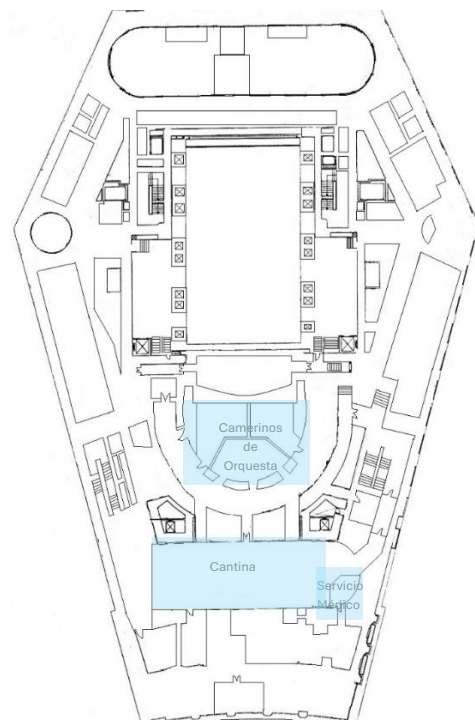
Planta -2. Camerinos de orquesta, servicio médico y cantina [13]
